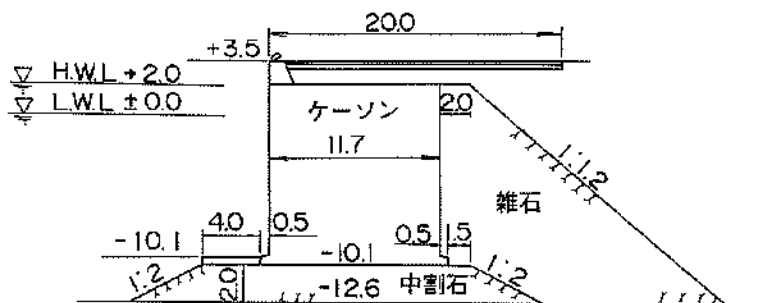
試設計による標準断面図 (設計震度0.20)
